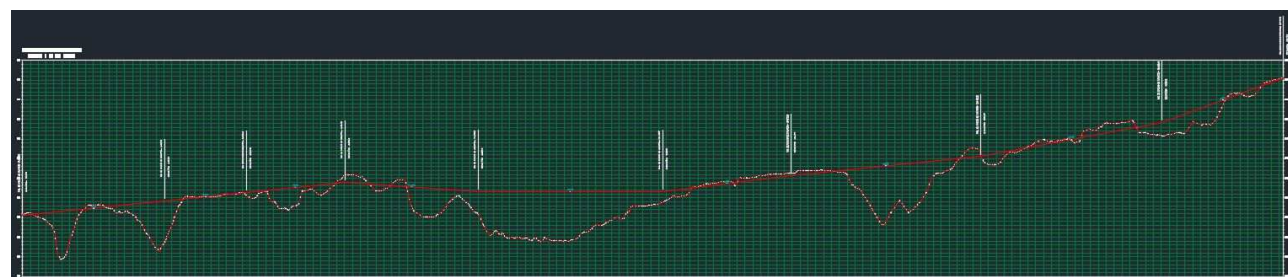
Perfil longitudinal de la alternativa previa Sur 1.
